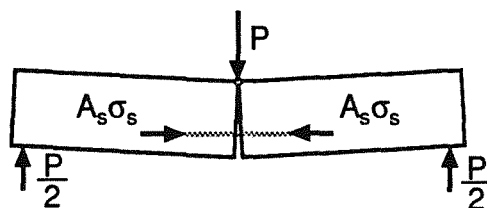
Cuando la fisura ha progresado mucho, la viga se comporta como este mecanismo formado por dos bloques rígidos unidos por una rótula y por la barra de acero anclada.
